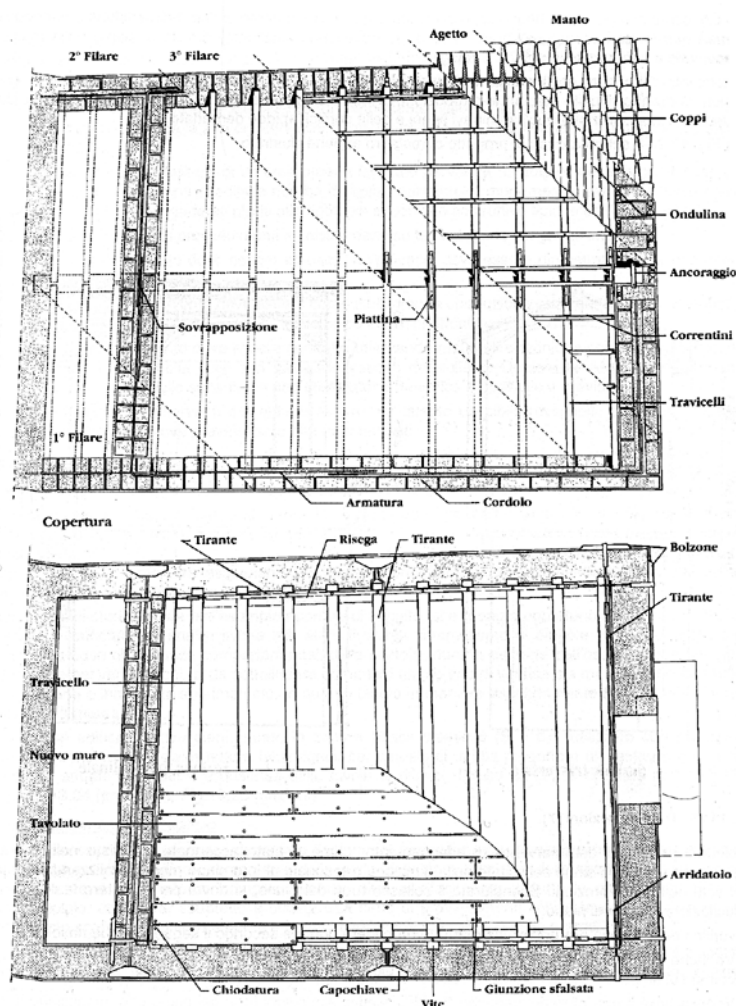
Esecutivi dell'intervento: solaio e copertura (7).
